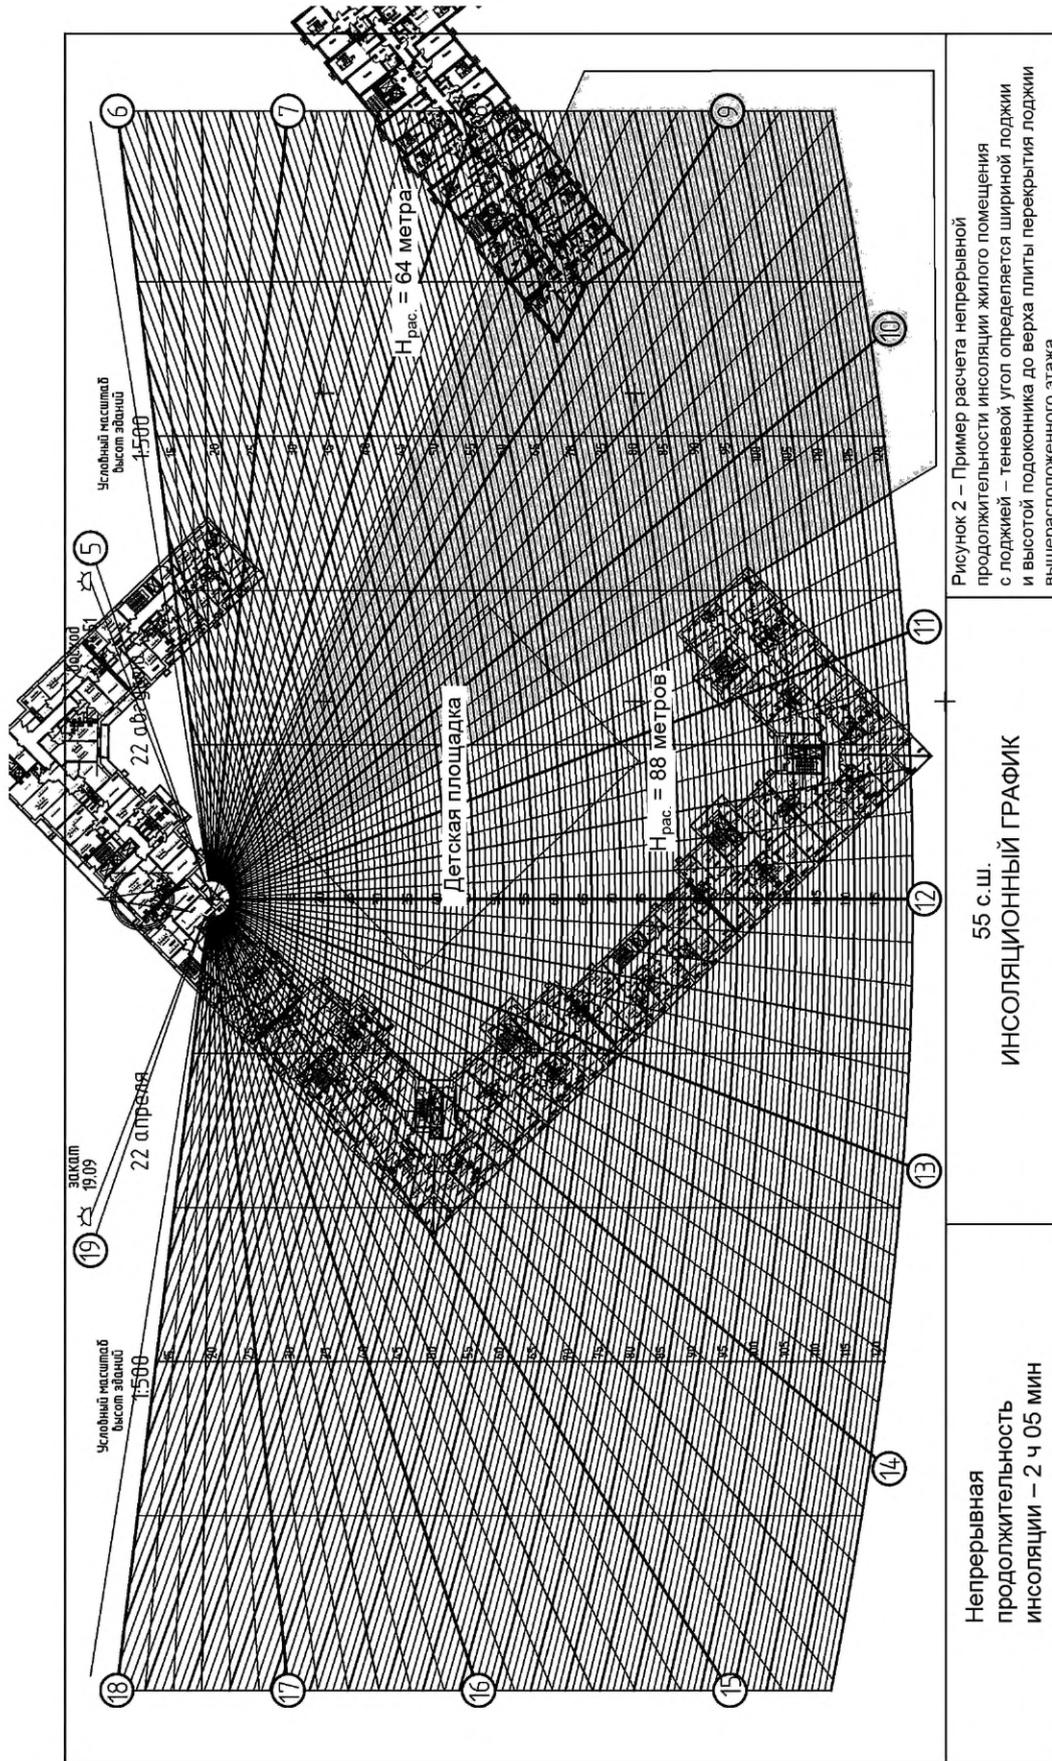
Пример расчета непрерывной инсоляции жилого помещения с лоджией (теневой угол определяется шириной лоджии и высотой от подоконника до верха плиты перекрытия лоджии вышерасположенного этажа)
